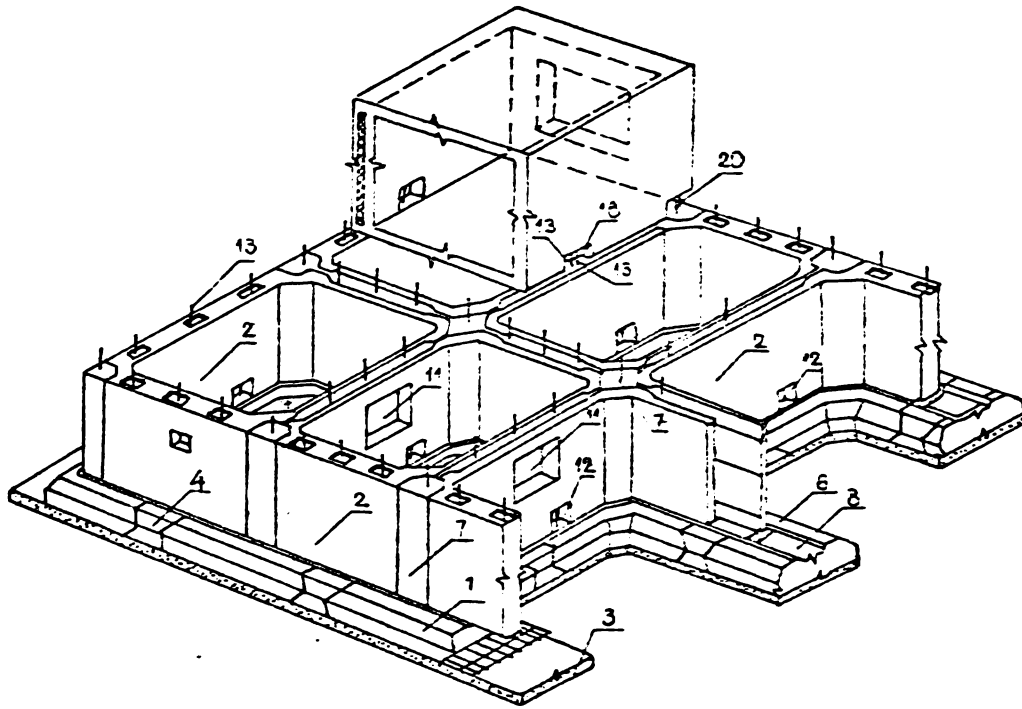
Ansamblul infrastructură prefabricată, varianta I :
